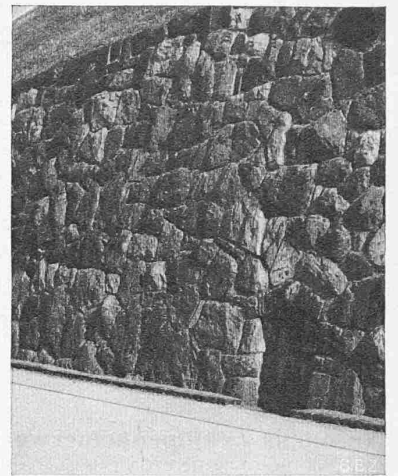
Zyklopen-Futtermauer aus bunten Findlingen an der Wallenseestrasse
